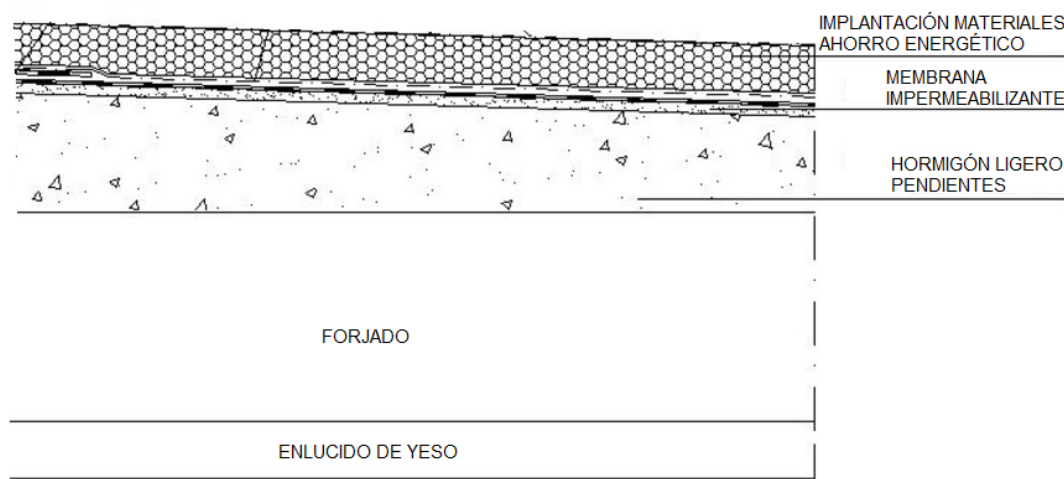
Estructura cubierta plana con posible adecuación a plana invertida[23].
